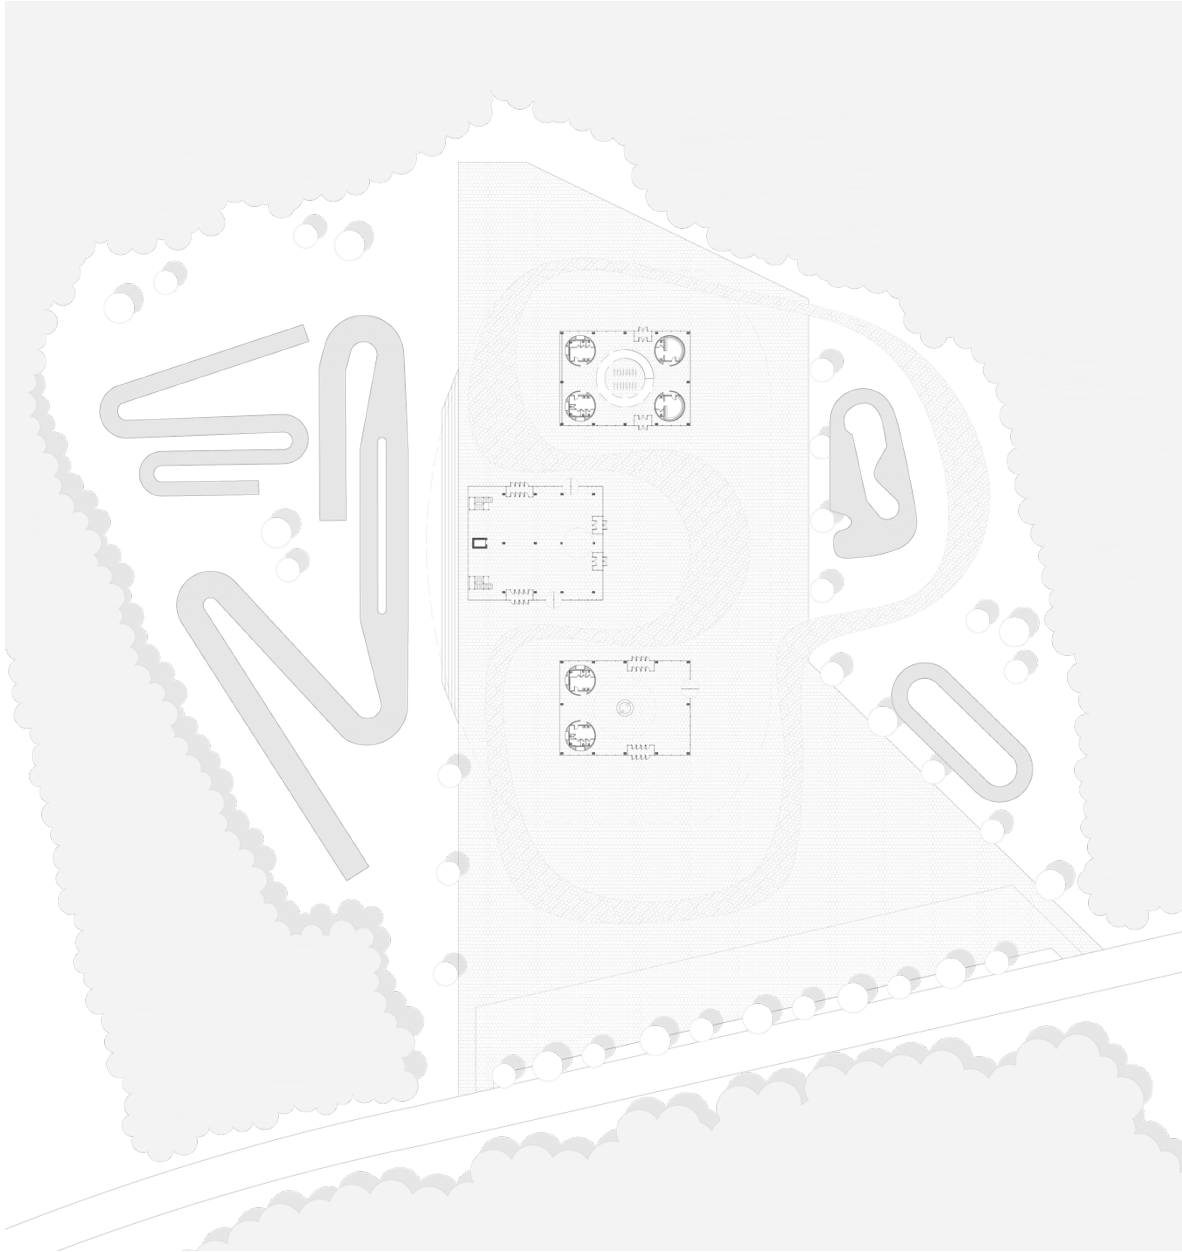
Implantation et rez-de-chaussée (par l'auteur)
